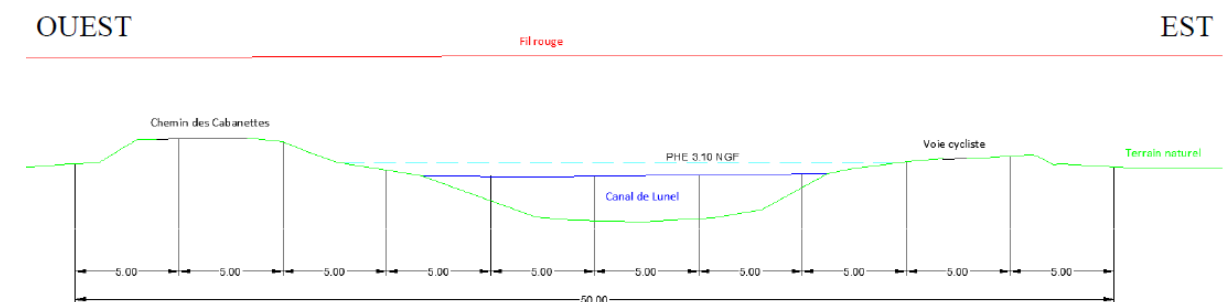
Profil en long au droit de l'ouvrage du canal de Lunel
